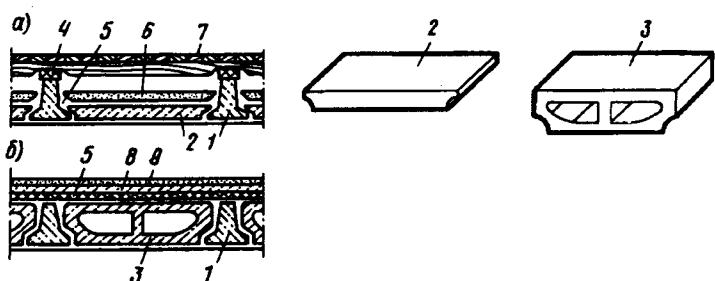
Конструкция балочного перекрытия по железобетонным балкам
